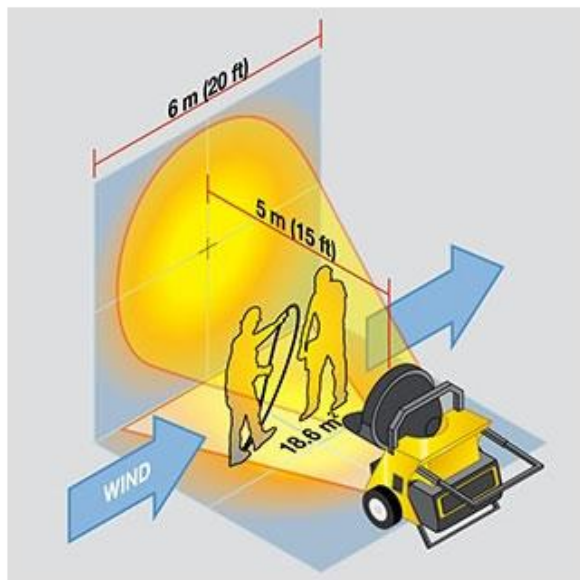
Общий вид прогрева конструкции ИК-излучателями
